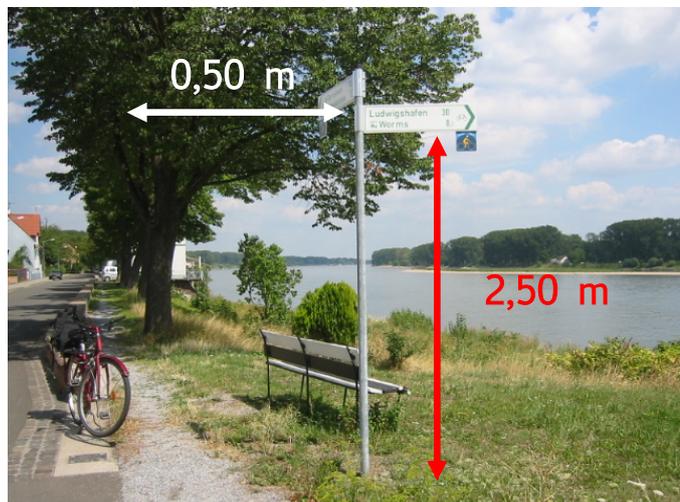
Bei zu geringem lichten Raum können Pfeilwegweiser ausnahmsweise mit dem Pfeil zum Mast montiert werden.
